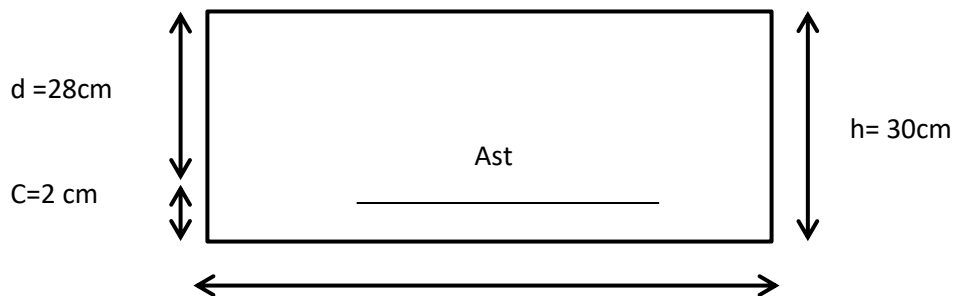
Schéma statique de ferrailage du mur plaque
